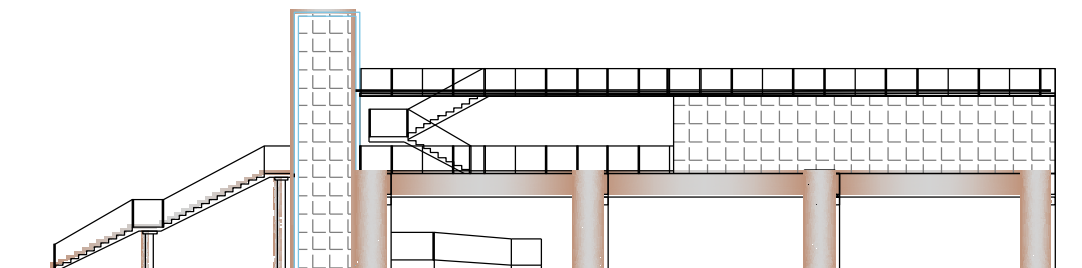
岛式车站（线间距 8.6m）立面图
